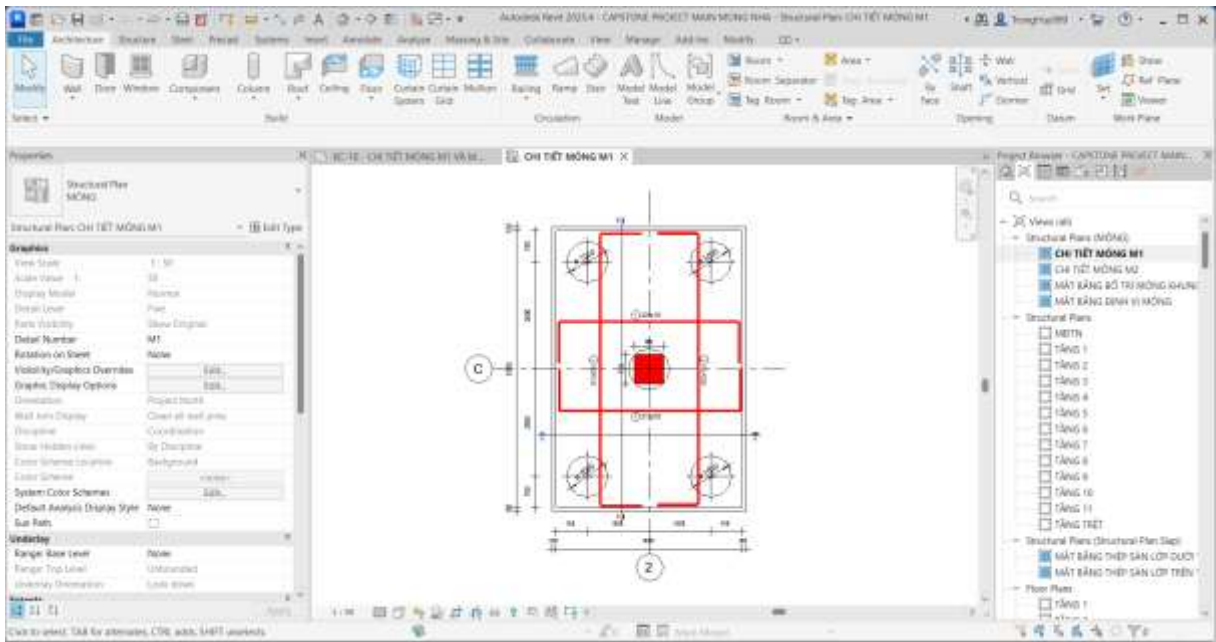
Vẽ chi tiết thép móng của công trình (Structural Rebar).
